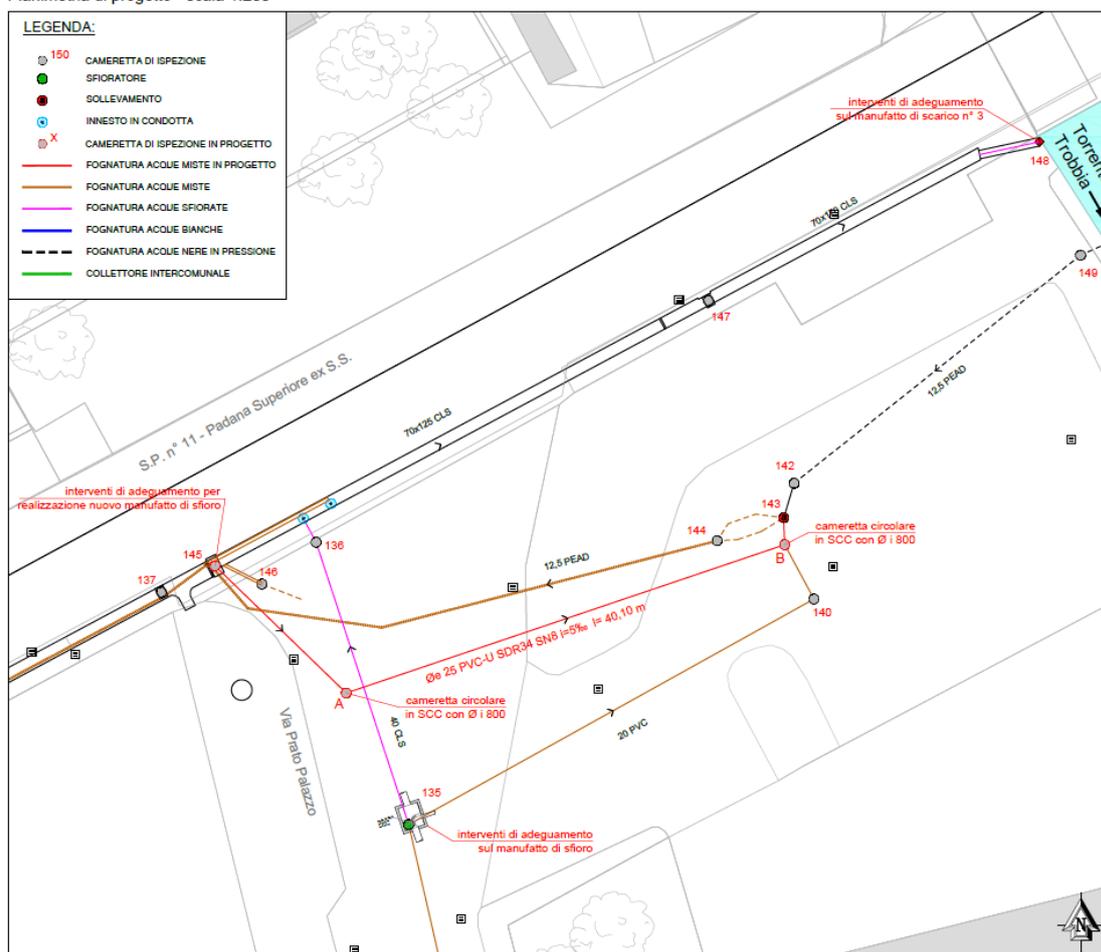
Planimetria stato di progetto intervento 2 – scarico n.3 (ID 148) e manufatti di sfioro (ID 135 e ID 145)
